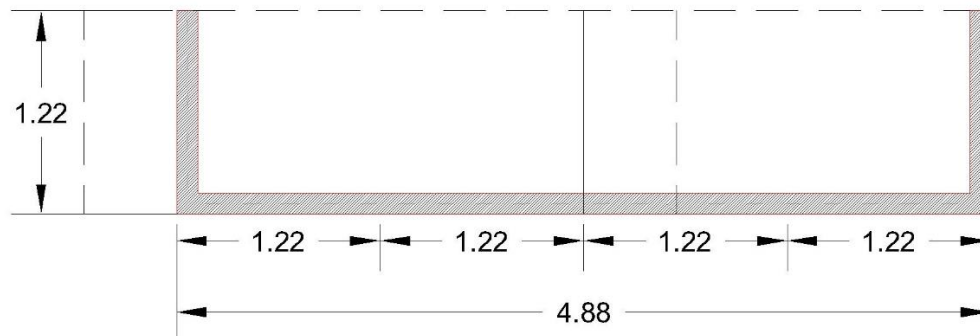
Planta y dimensiones de modulo tipo (esquema elaborado por el autor)
